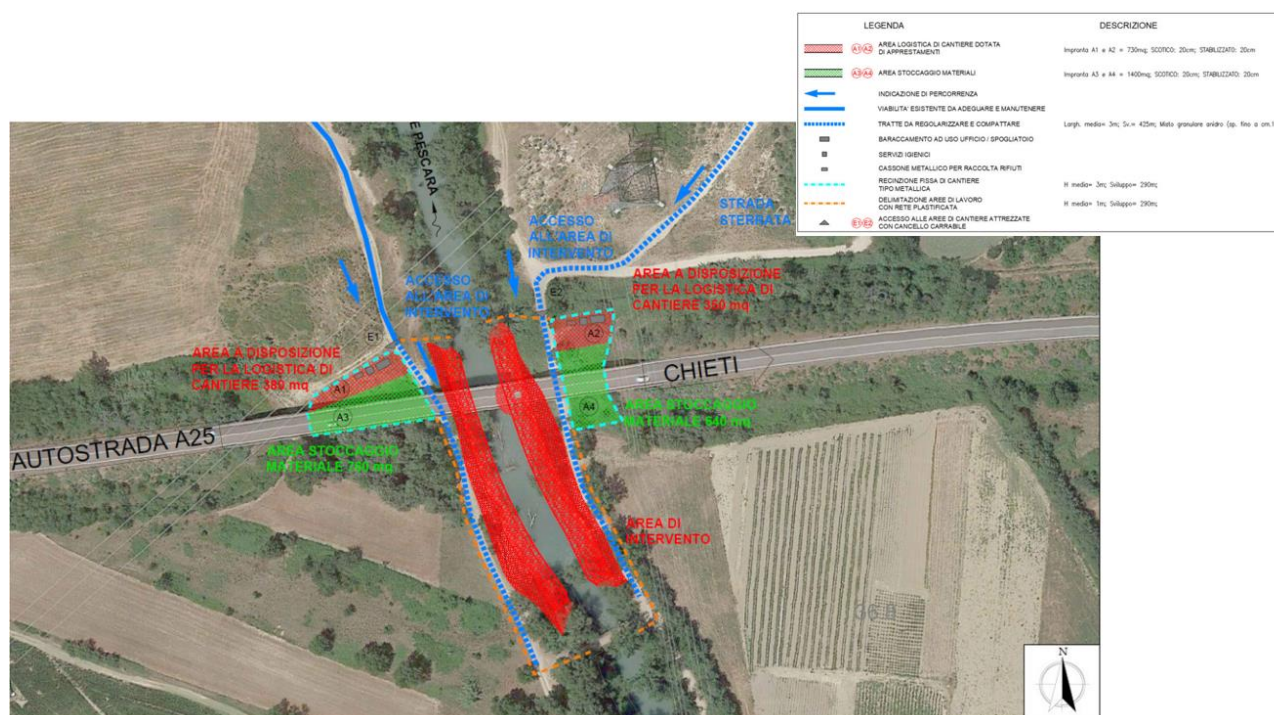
Planimetria di cantierizzazione e definizione aree di cantiere
